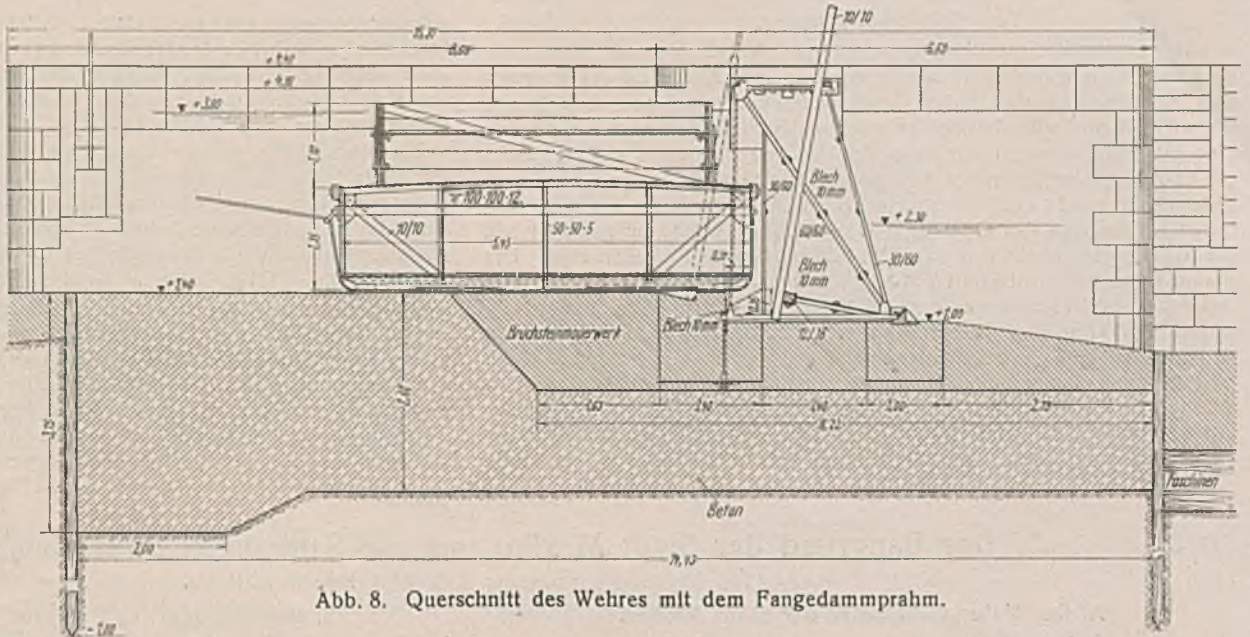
Querschnitt des Wehres mit dem Fangedammprahm.
